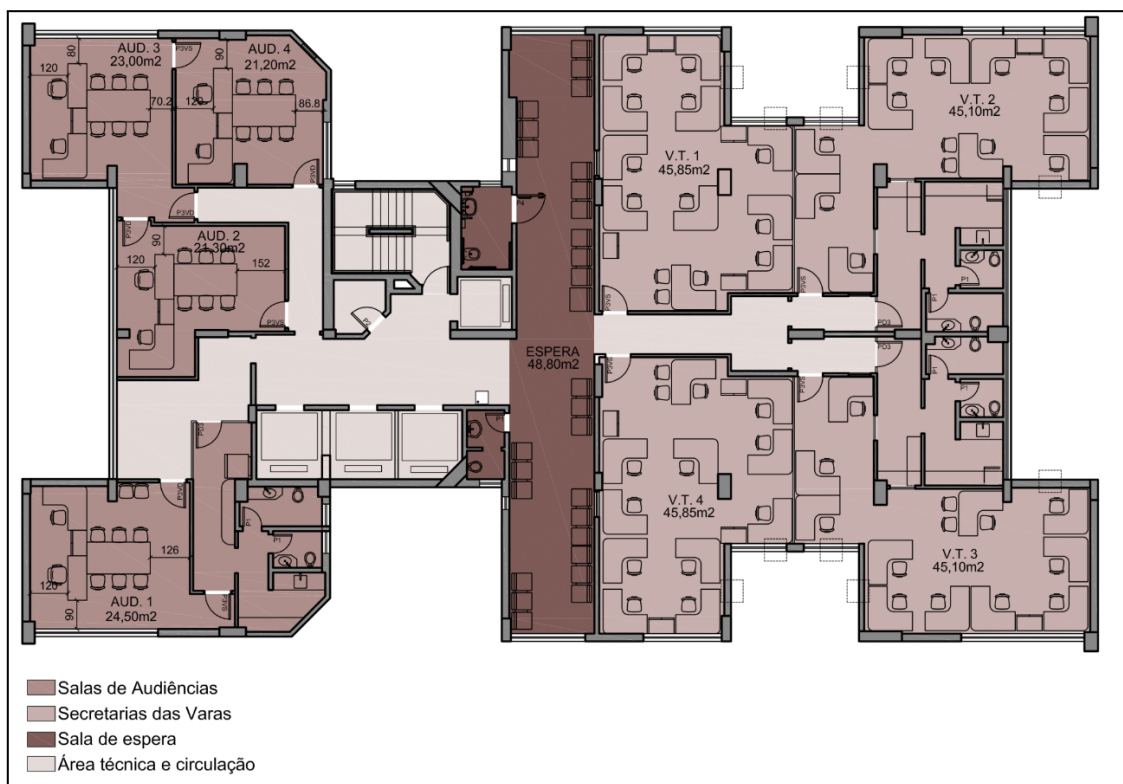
Planta do pavimento tipo atual (sem gabinete de juiz).
